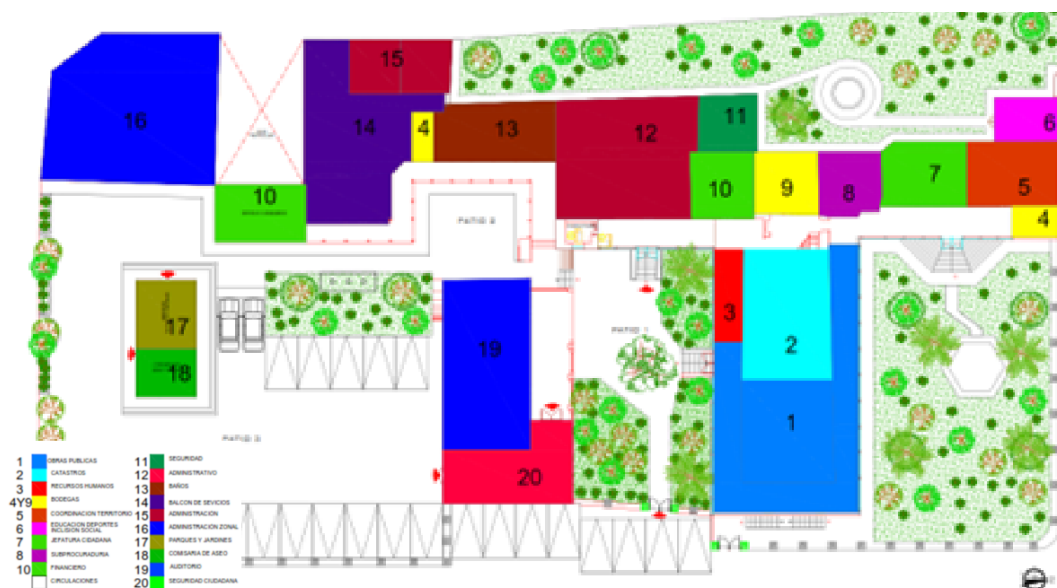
Distribución interna de usos – planta baja (Montenegro, 2017)
